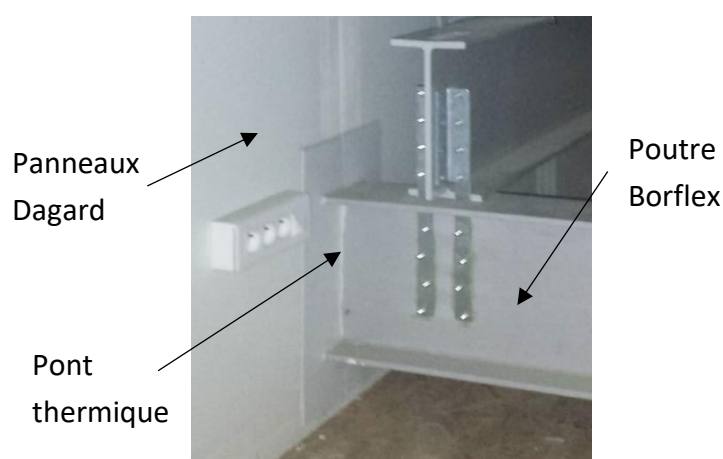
Présentation du pont thermique dû à la traversée des poutres
